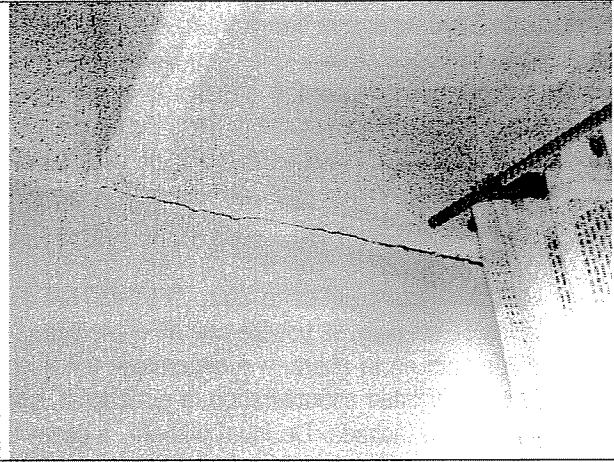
Grieta horizontal que separa la losa de cubierta y un muro estructural de la edificación, tercer nivel.
